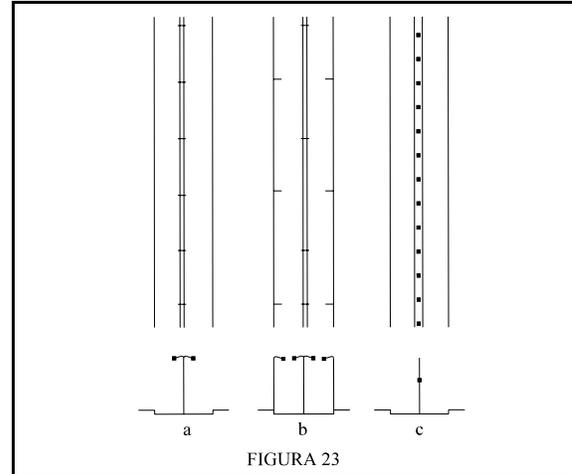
Disposición de luminarias para autopistas y vías de dos calzadas :
